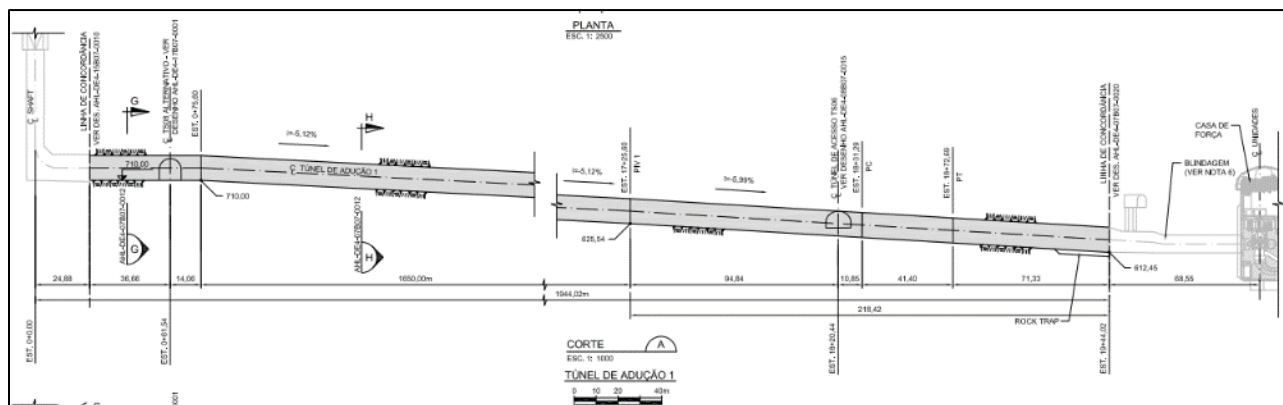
Corte longitudinal tipo dos túneis de adução (adaptado de Intertechne, 2014)
